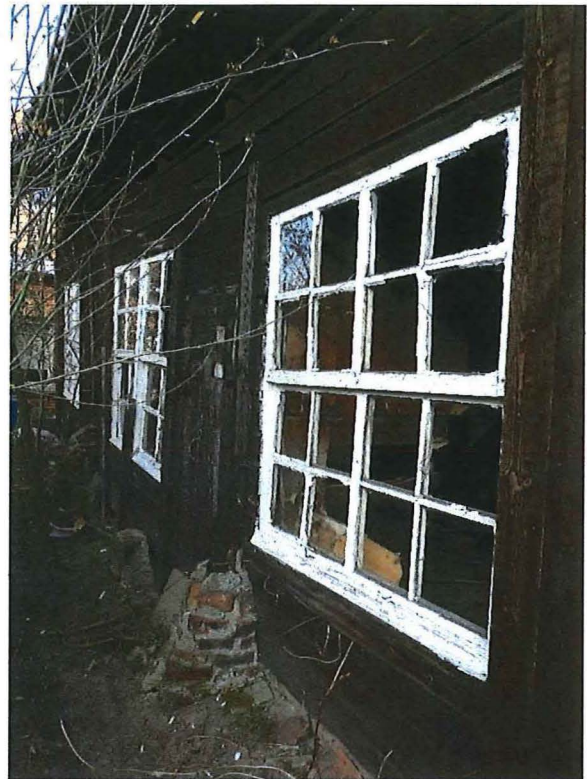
Straatgevel van de blokstal in houtbouw met kenmerkende blokvensters en steunberen.
